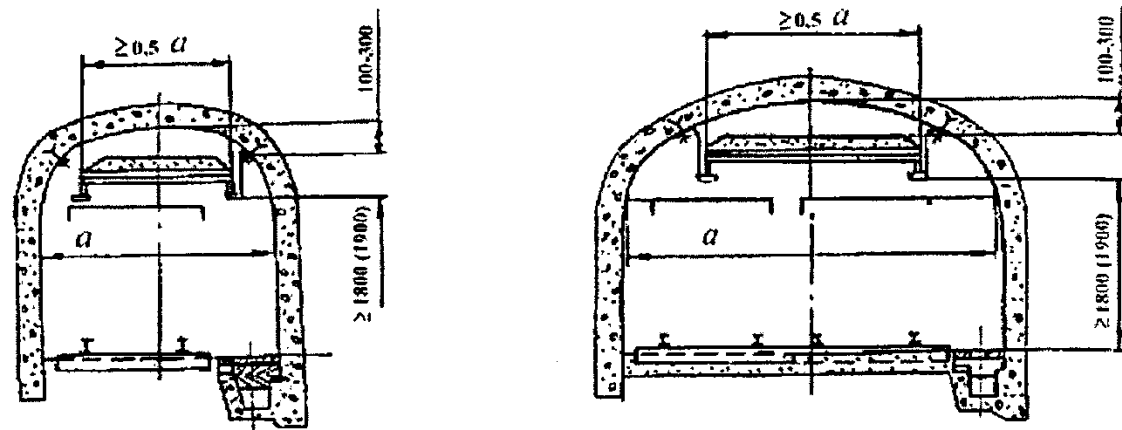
Схема установки сланцевых заслонов в выработках, закрепленных бетонной крепью
